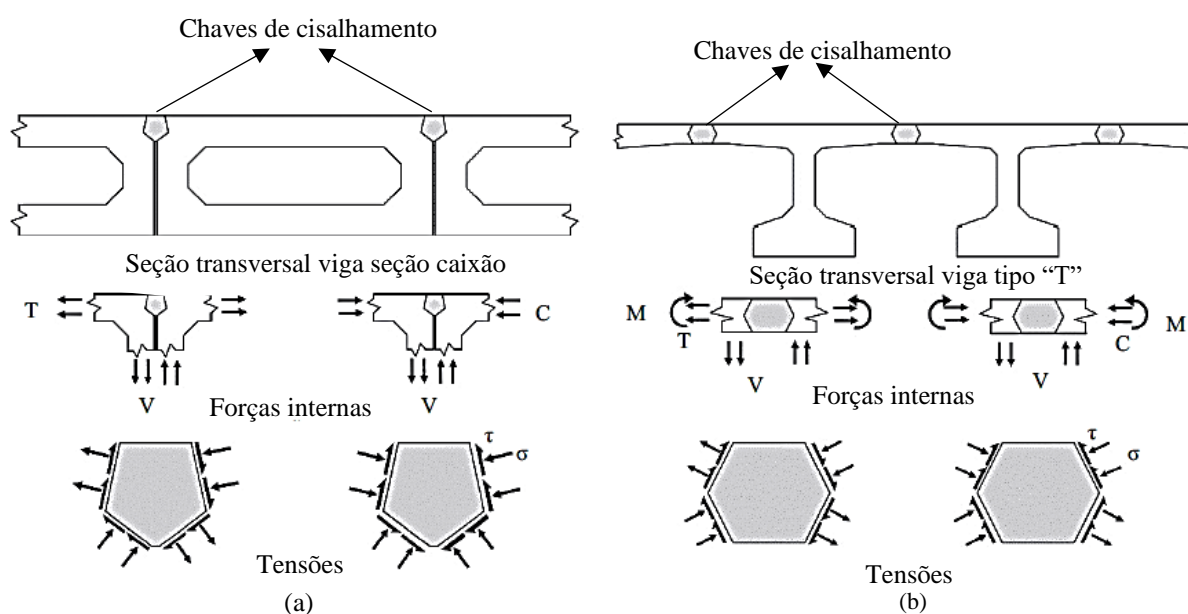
Seções transversais típicas de ponte e distribuição dos esforços: (a) viga caixão adjacente; (b) viga de seção "T" (Fonte: HUSEIN et al., 2017)
